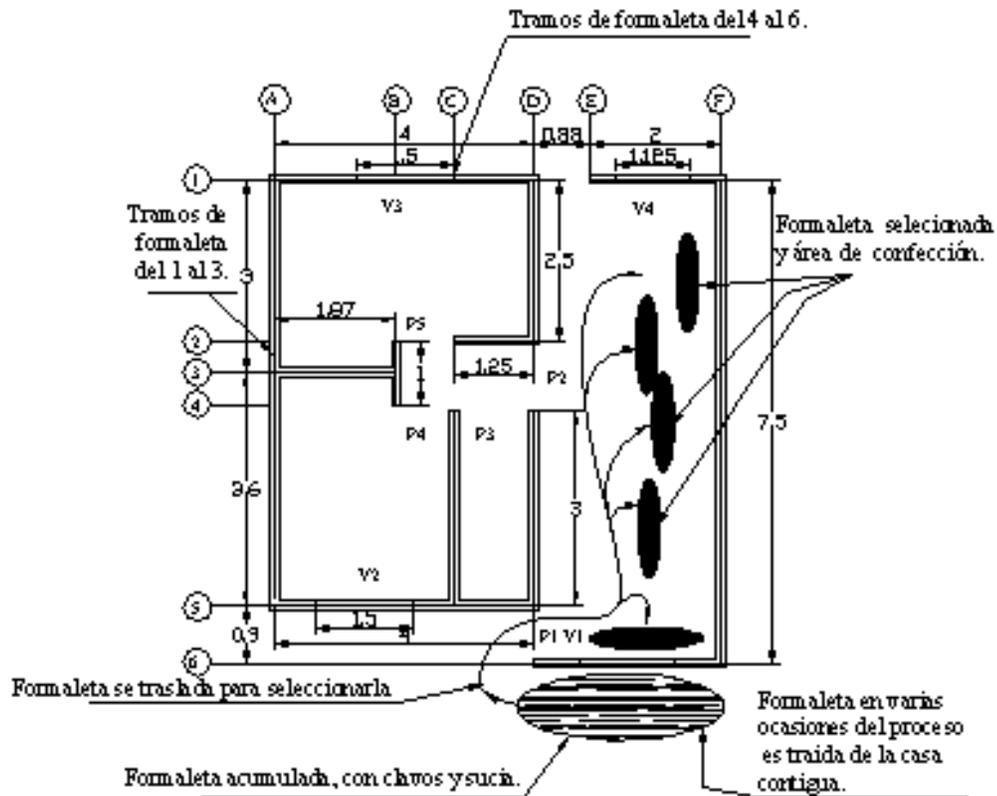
Planta arquitectonica. Zona de colocación de formaleta y área de confección.
